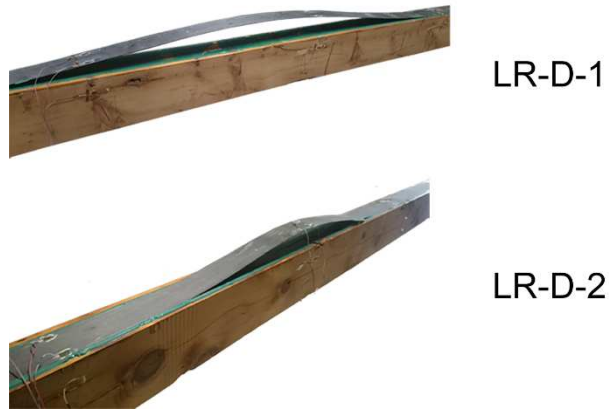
Imágenes de las roturas de las vigas con refuerzo longitudinal de gran escuadría (LR). Arriba: LR-D-1. Abajo: LR-D-2. Casa comercial: DRIZORO®.
